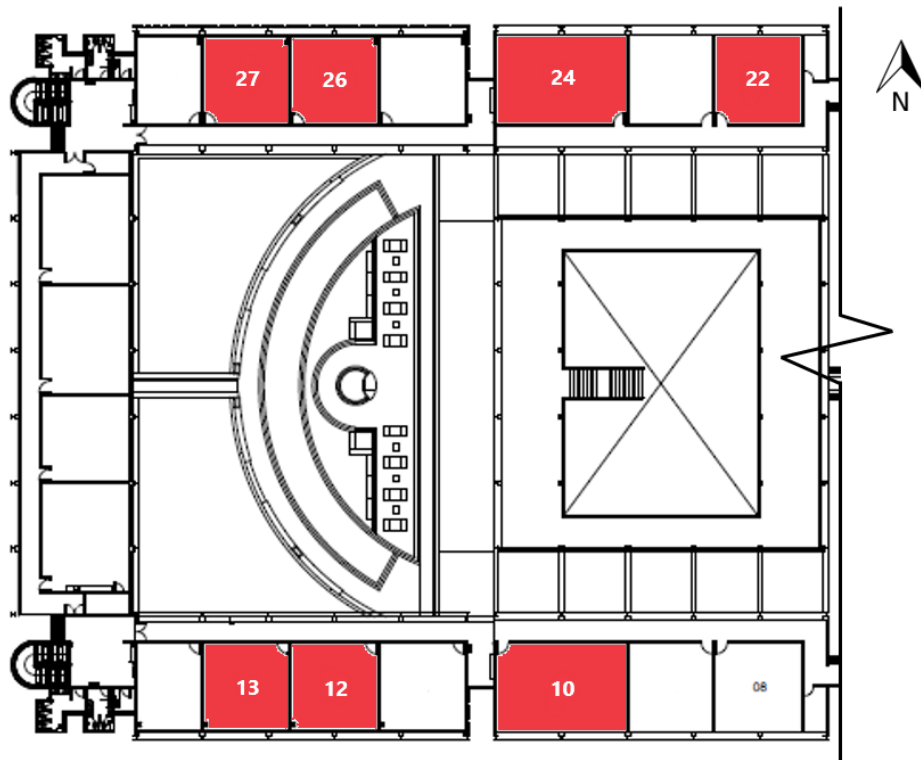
Planta baixa esquemática: Escola de Minas
